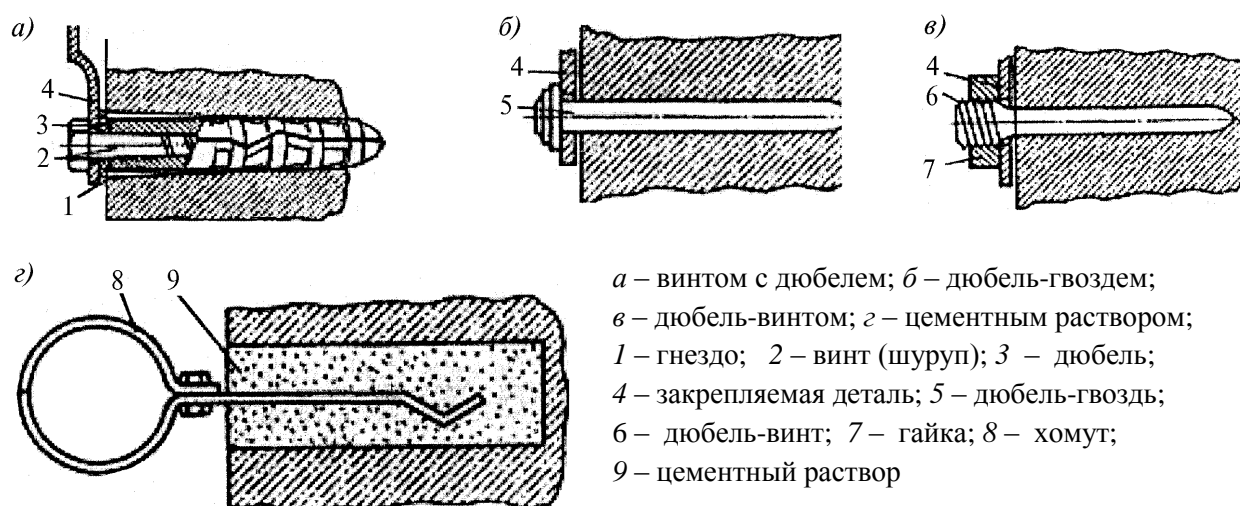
Установка крепежа водопроводов в строительных конструкциях
